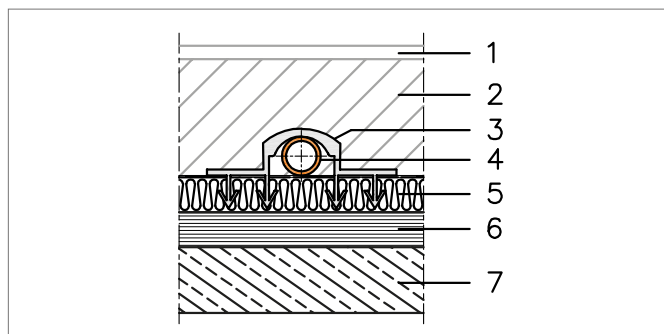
Prinzipaufbau System RAUTAC 10 mit Zusatzdämmung
